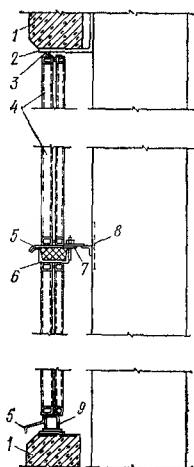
Крепление переpleтов серии 1.436-6 к железобетонной колонне
